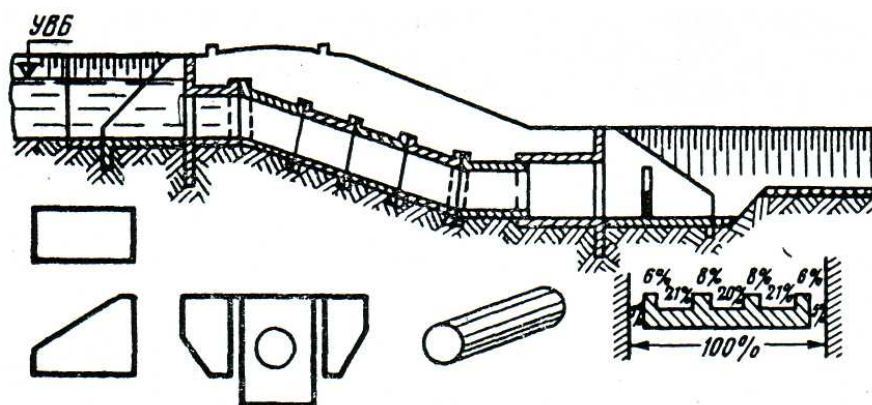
Трубчатый быстроток-регулятор сборной конструкции
